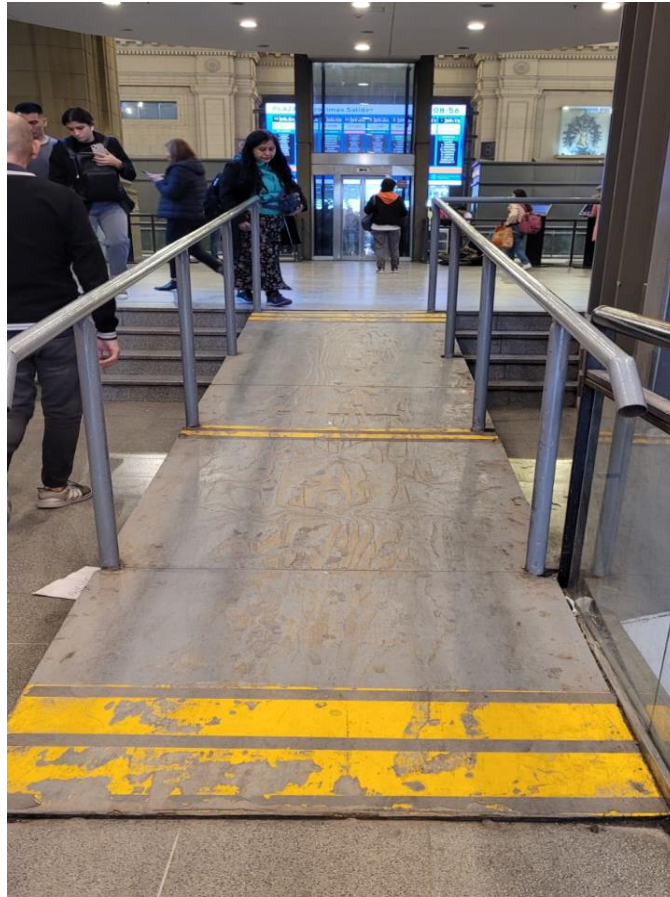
Rampa provisoria de madera en el hall de la estación. Fuente: JST, 2023
